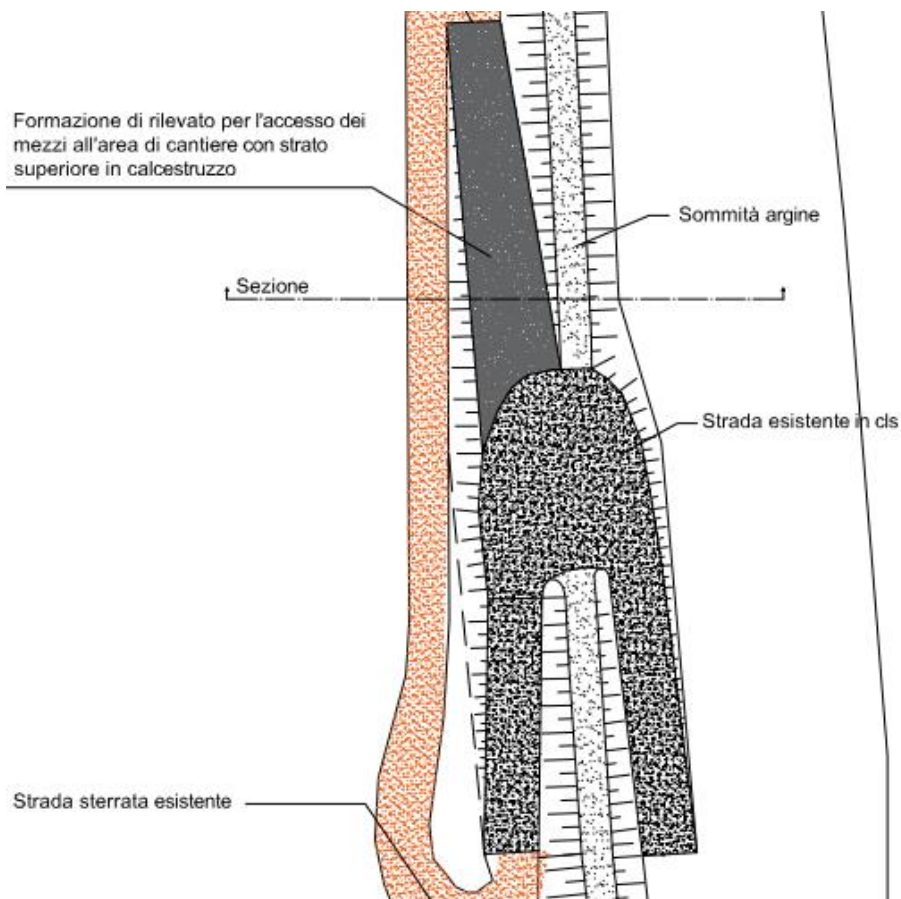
Planimetria generale e particolare della rampa a di accesso al cantiere.
